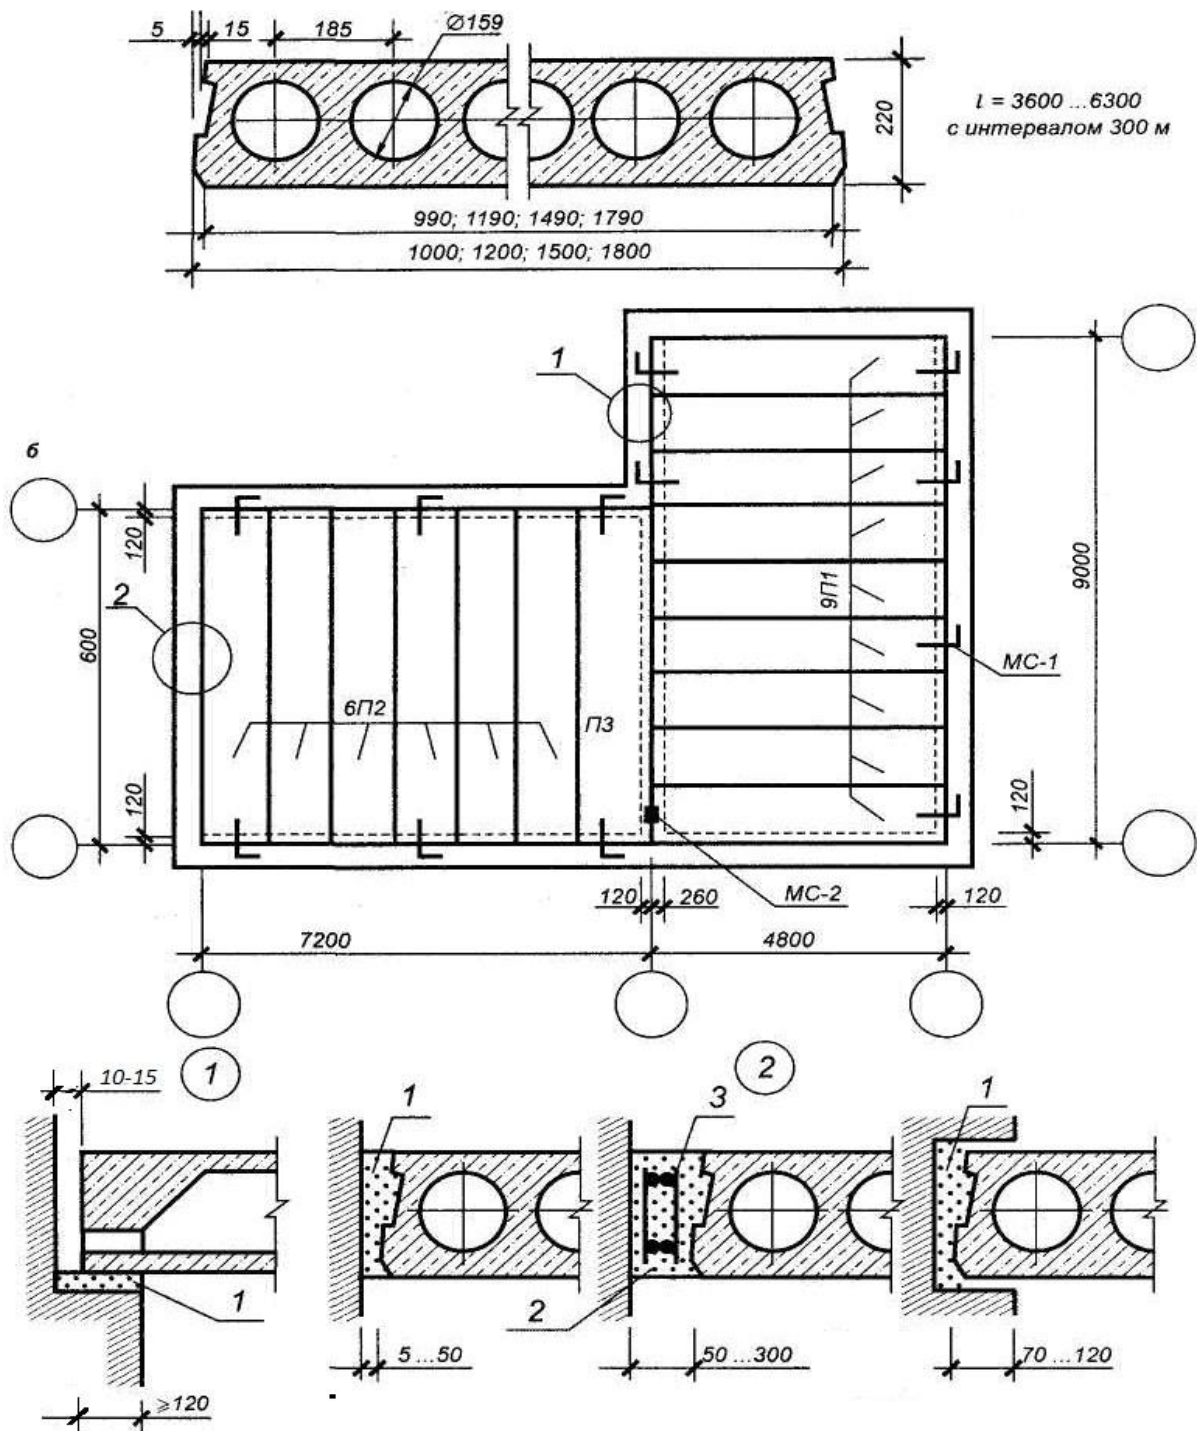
Плита перекрытия типа 1ПК, план перекрытия и детали опирания на стену и примыкания к ней:
